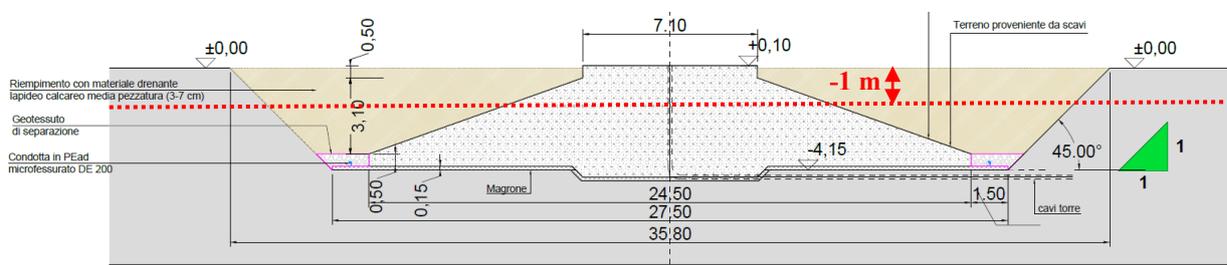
Schema del plinto di fondazione e della demolizione per il ripristino.
